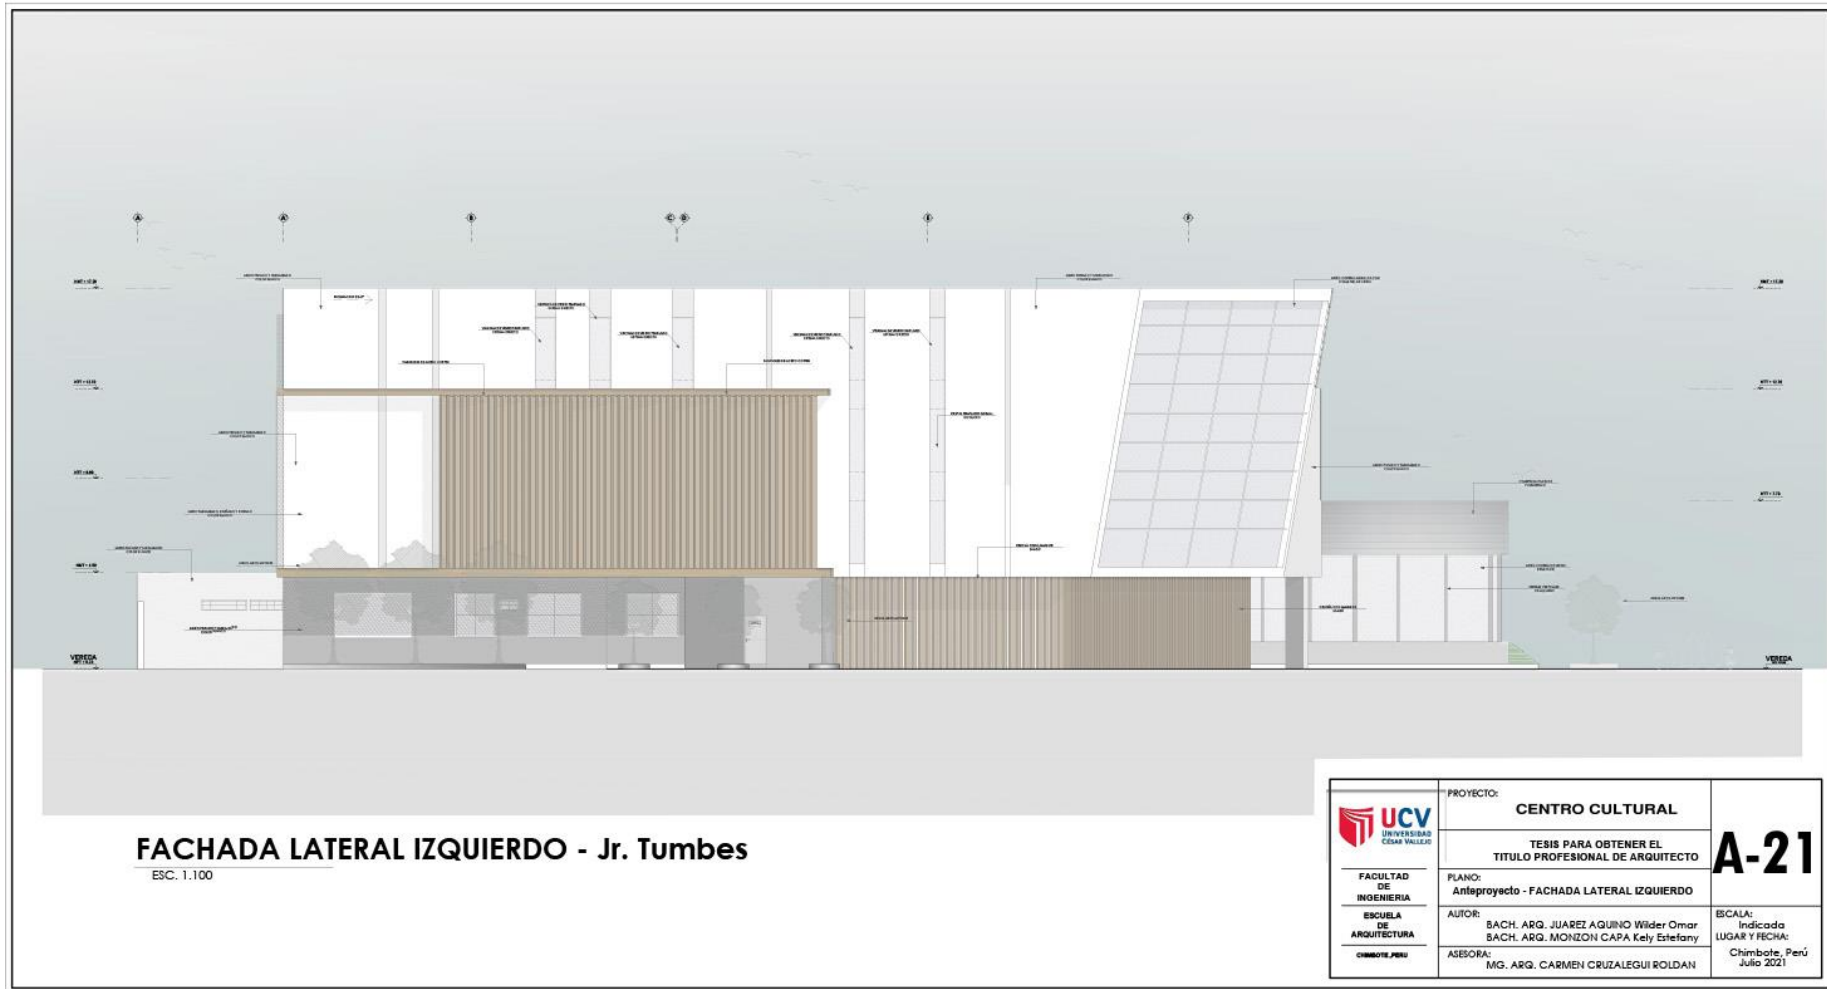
Fachada Lateral Izquierdo – Jr. Tumbes
